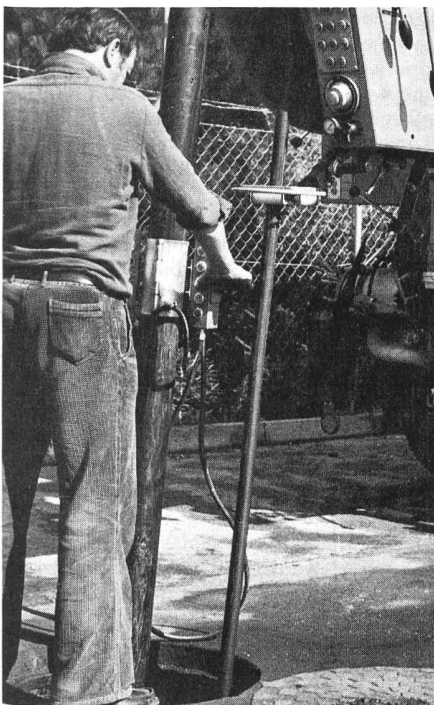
Spül- und Saugeinsatz: Die wichtigsten Funktionen sind vom Saugrüsselhandgriff über Kabel fernsteuerbar. Die Bewegung des Saugrüssels erfolgt hydraulisch.
